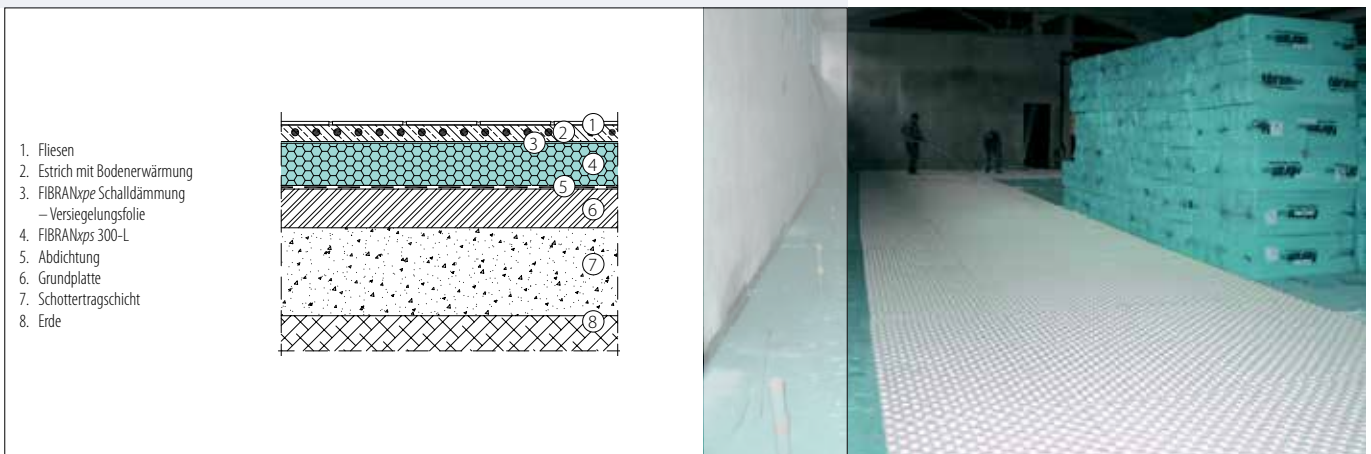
Schutz des Fundamentes und der Grundplatte. Ausführung der Abdichtung vor dem Anbringen der Wärmedämmung FIBRANxps 300-L.
